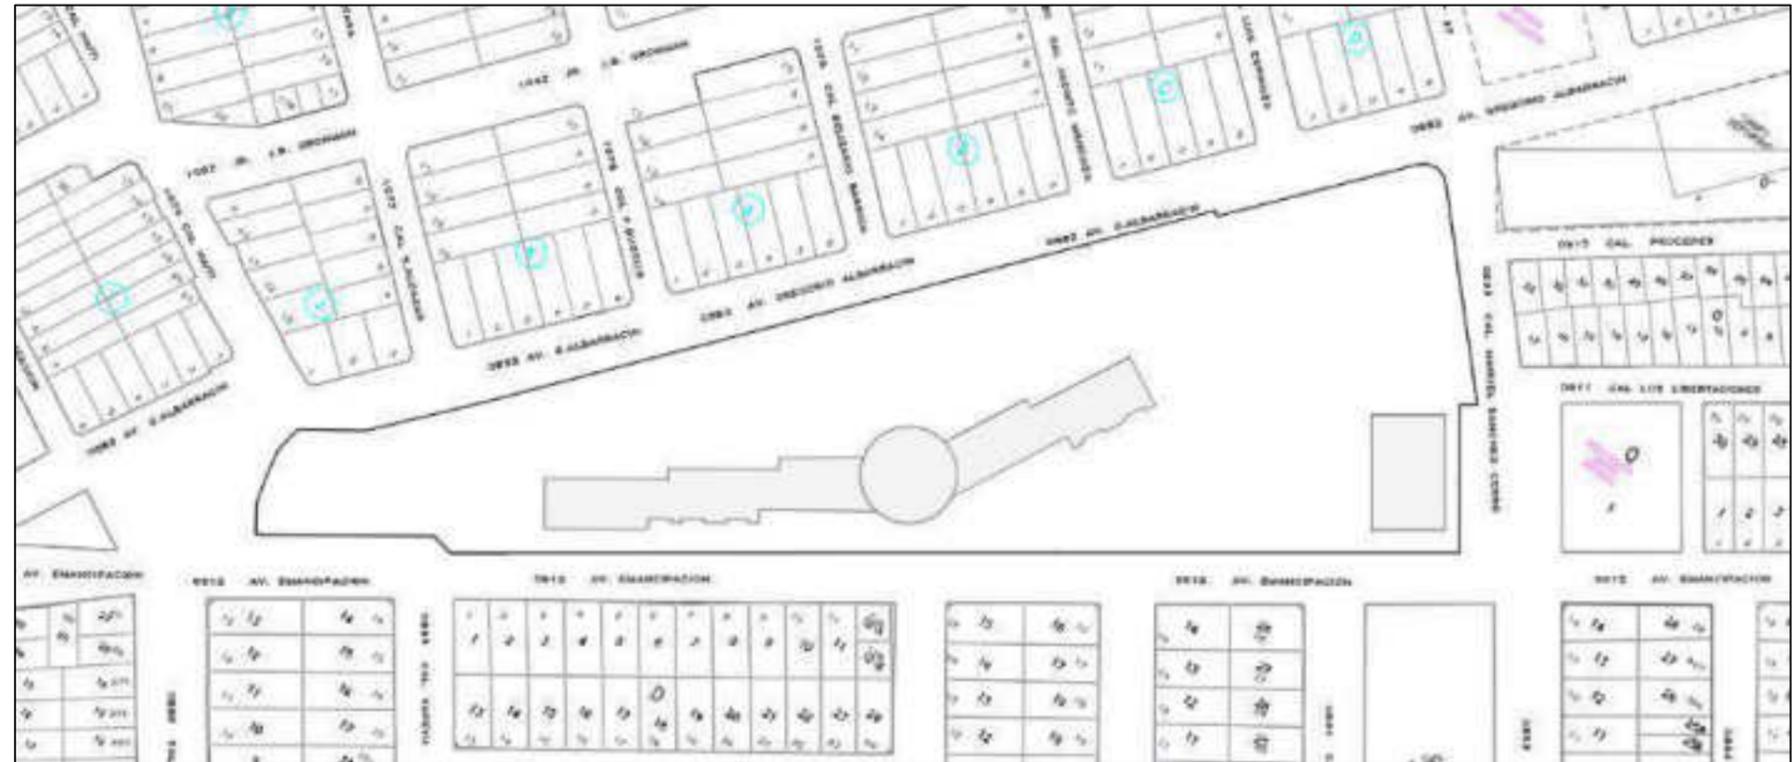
Estado actual del terminal terrestre “Collasuyo”
